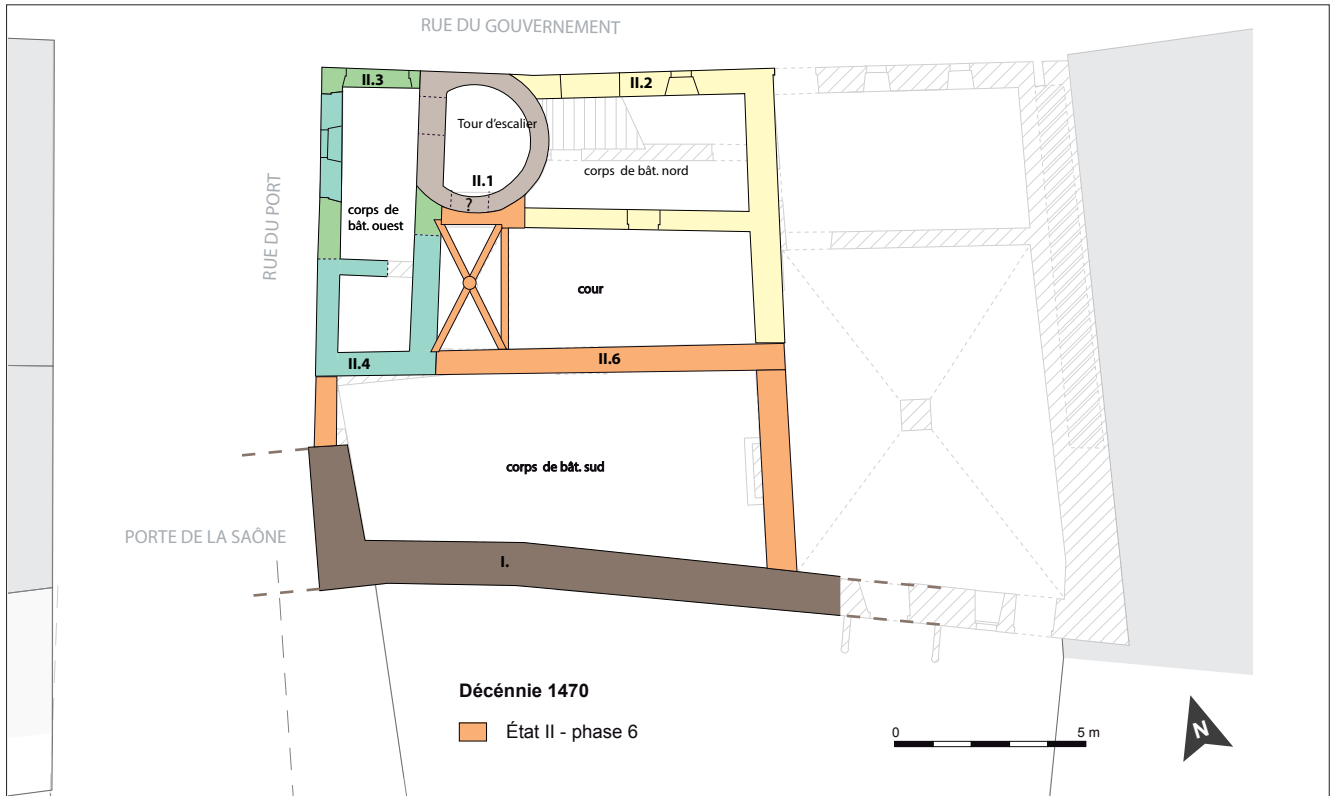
Illustration L : État II, phase 6 : Restitution en plan du corps de bâtiment sud - (éch. : 1/200).
